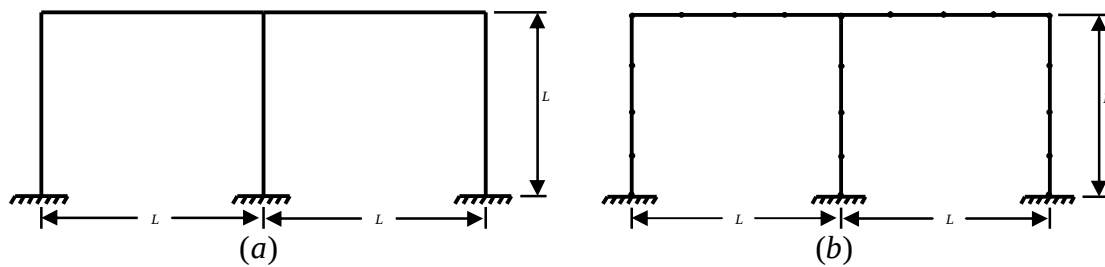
ã (a) Pórtico plano e (b) discretização
